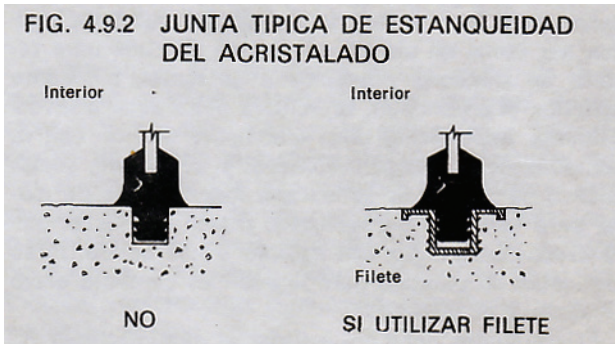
Propuesta de mejora para la junta embebida entre el vidrio y el panel de hormigón mediante incorporación de perfil omega
